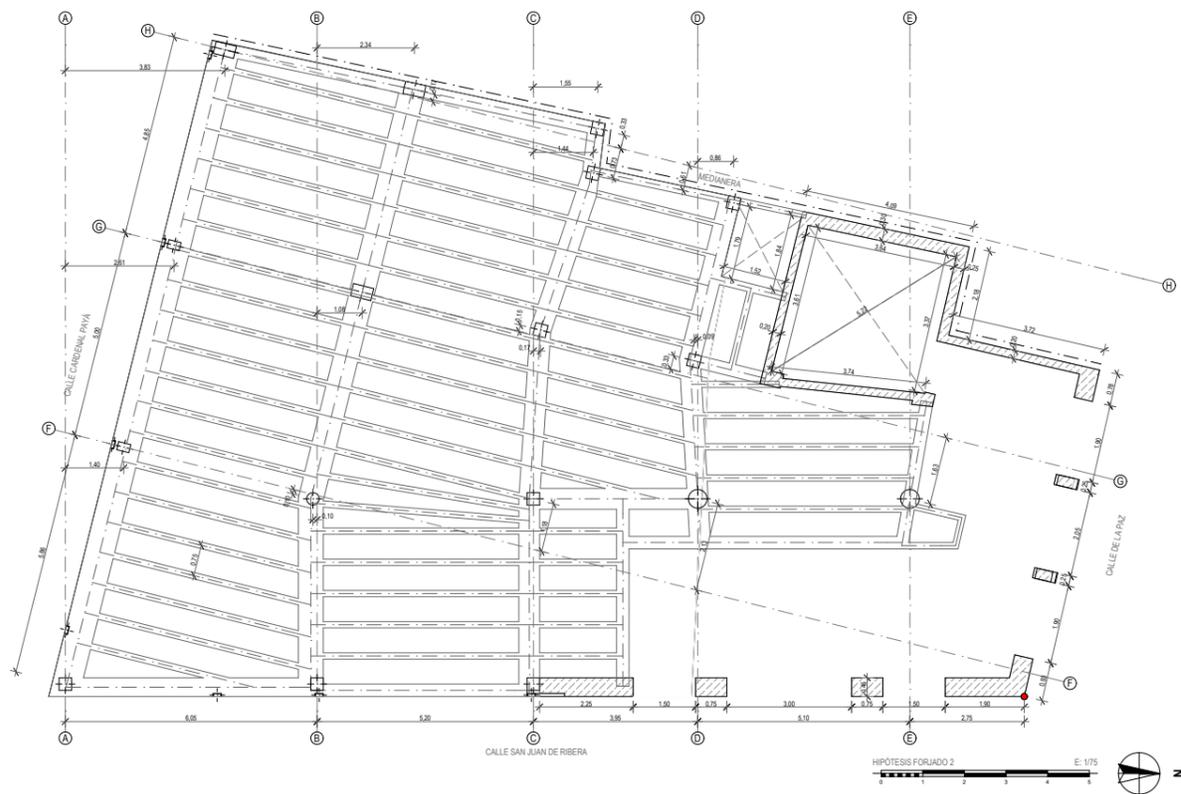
Modelo BIM Archicad. Plano estructura forjado 2.
